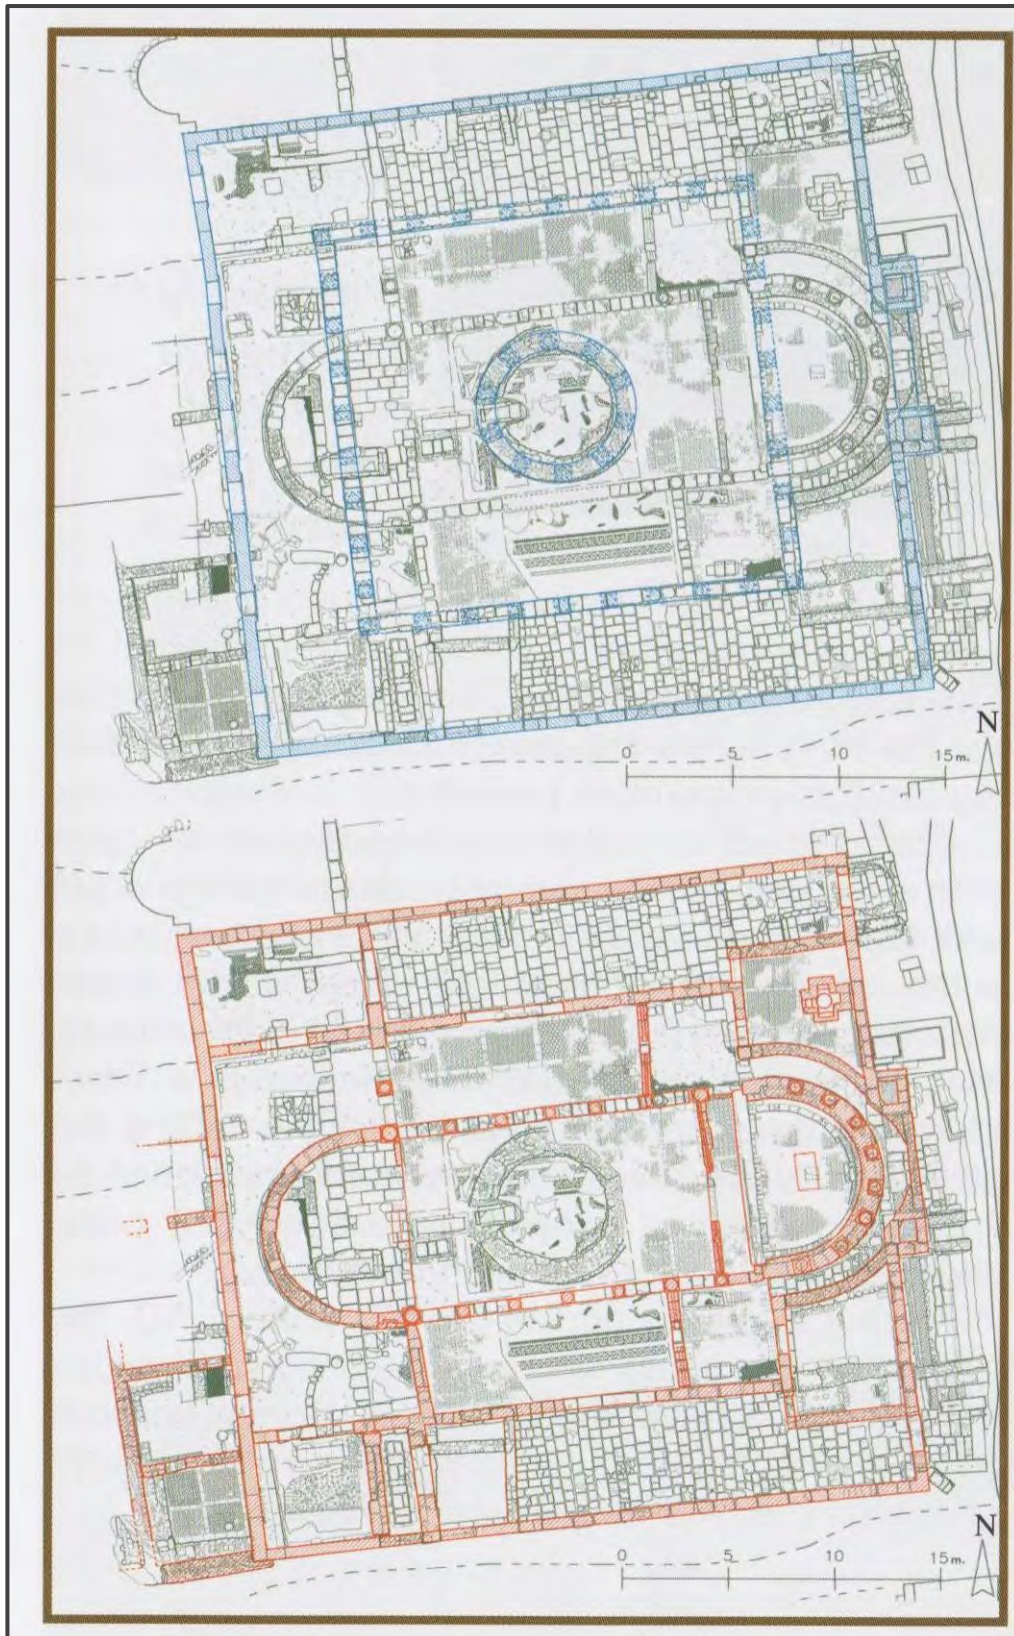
Elaiussa Sebaste 1. Rilievo planimetrico del complesso, fasi I-II
